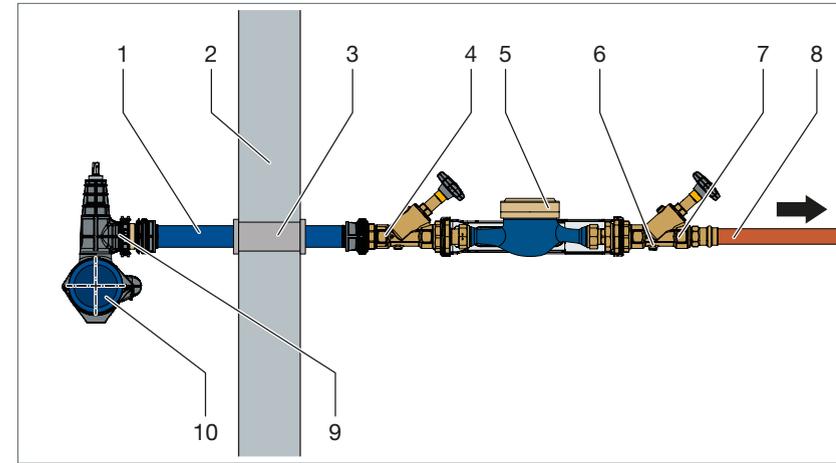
Trinkwasser-Hausanschluss durch Wand
